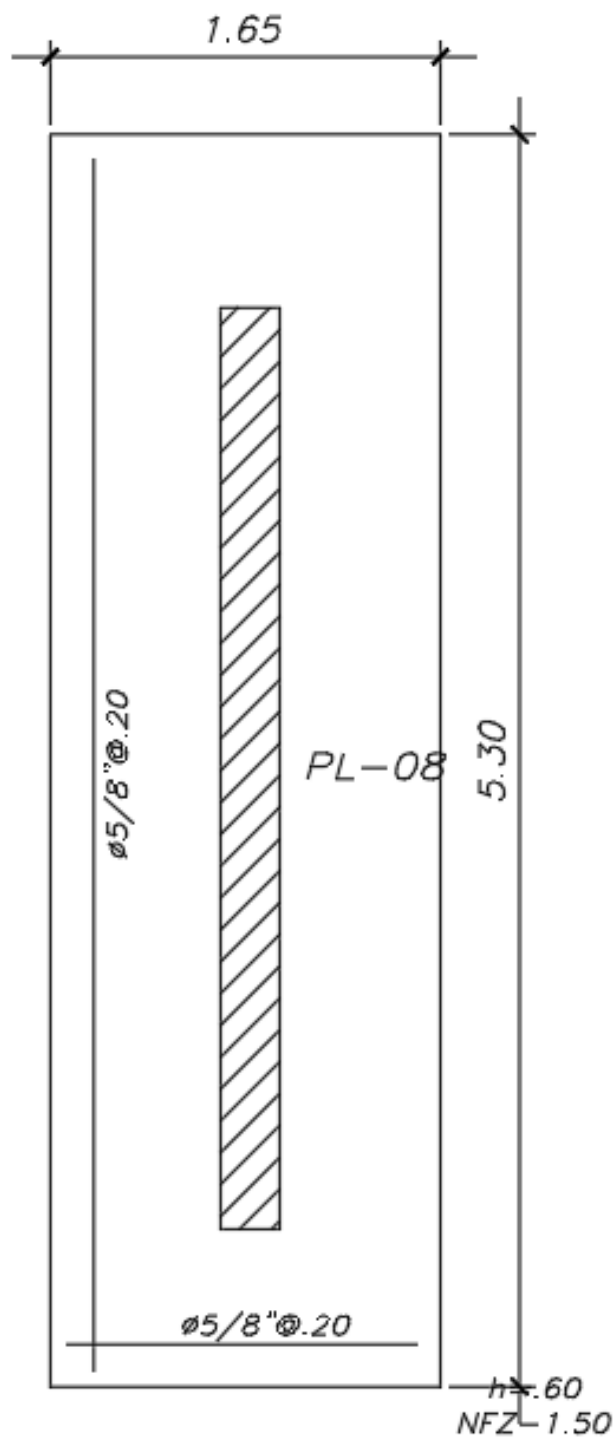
Diseño de la zapata aislada para la Placa PL-08 ($h=0.60$ m)
